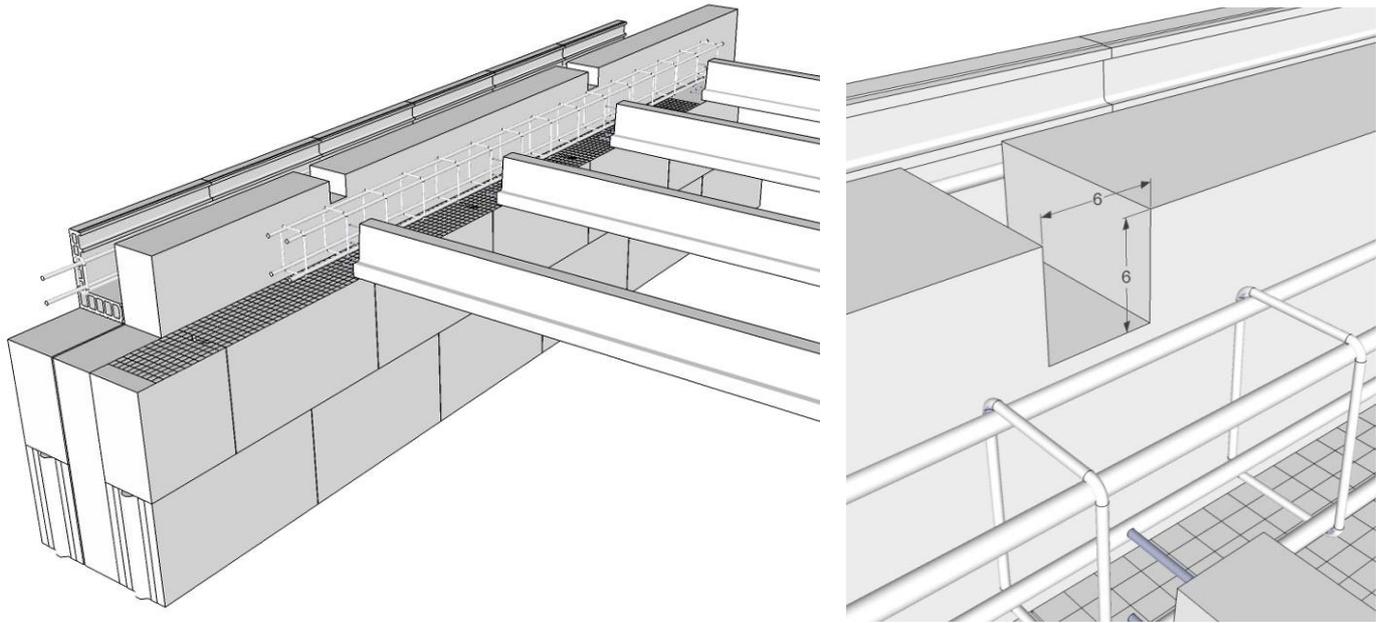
Jonction refend ép. 15cm/ Façade avec chaînages verticaux
